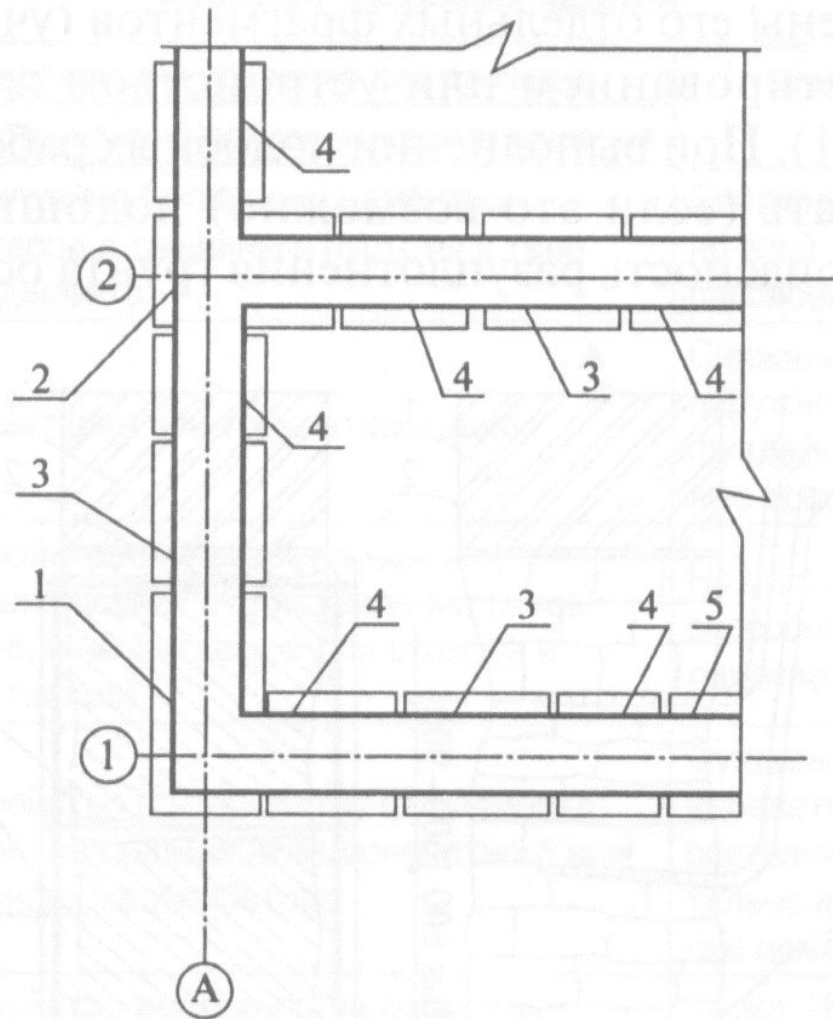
Рекомендуемая последовательность выполнения работ по усилению фундамента:
